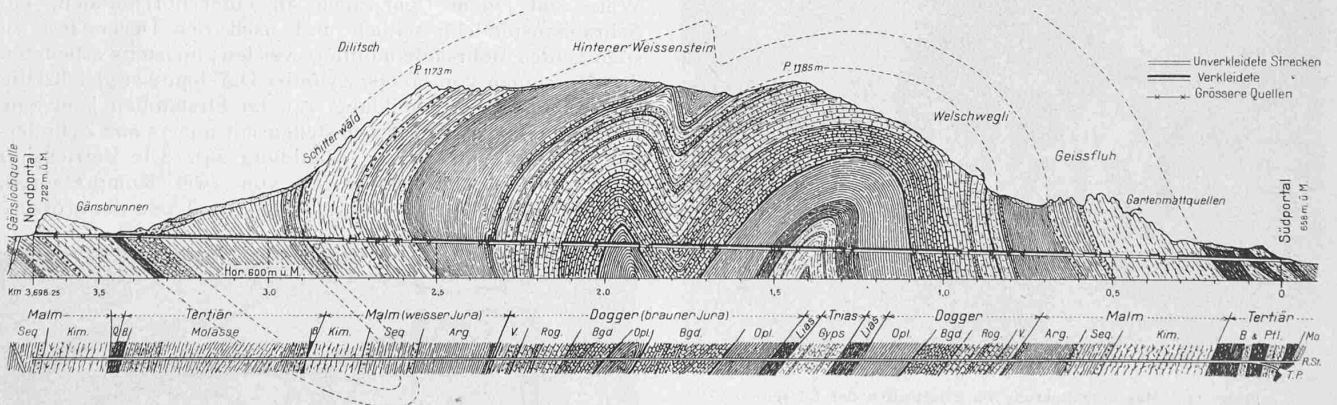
Vereinfachtes geologisches Profil mit Grundriss längs des Weissenstein-Tunnels der Solothurn-Münsterbahn. — Masstab 1 : 20000.
